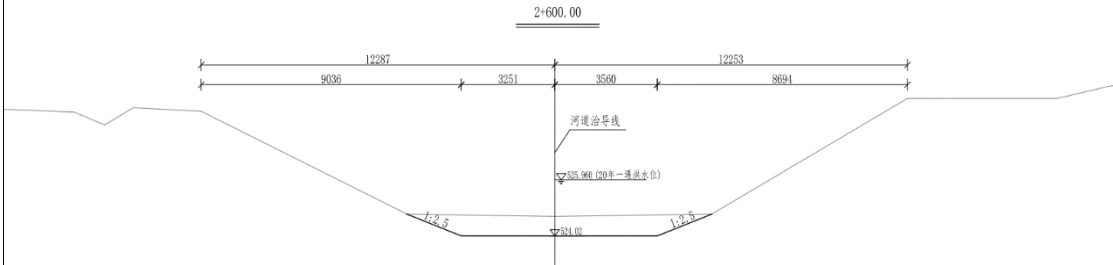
西拨子河西支桩号 2+600 断面设计横断面图
